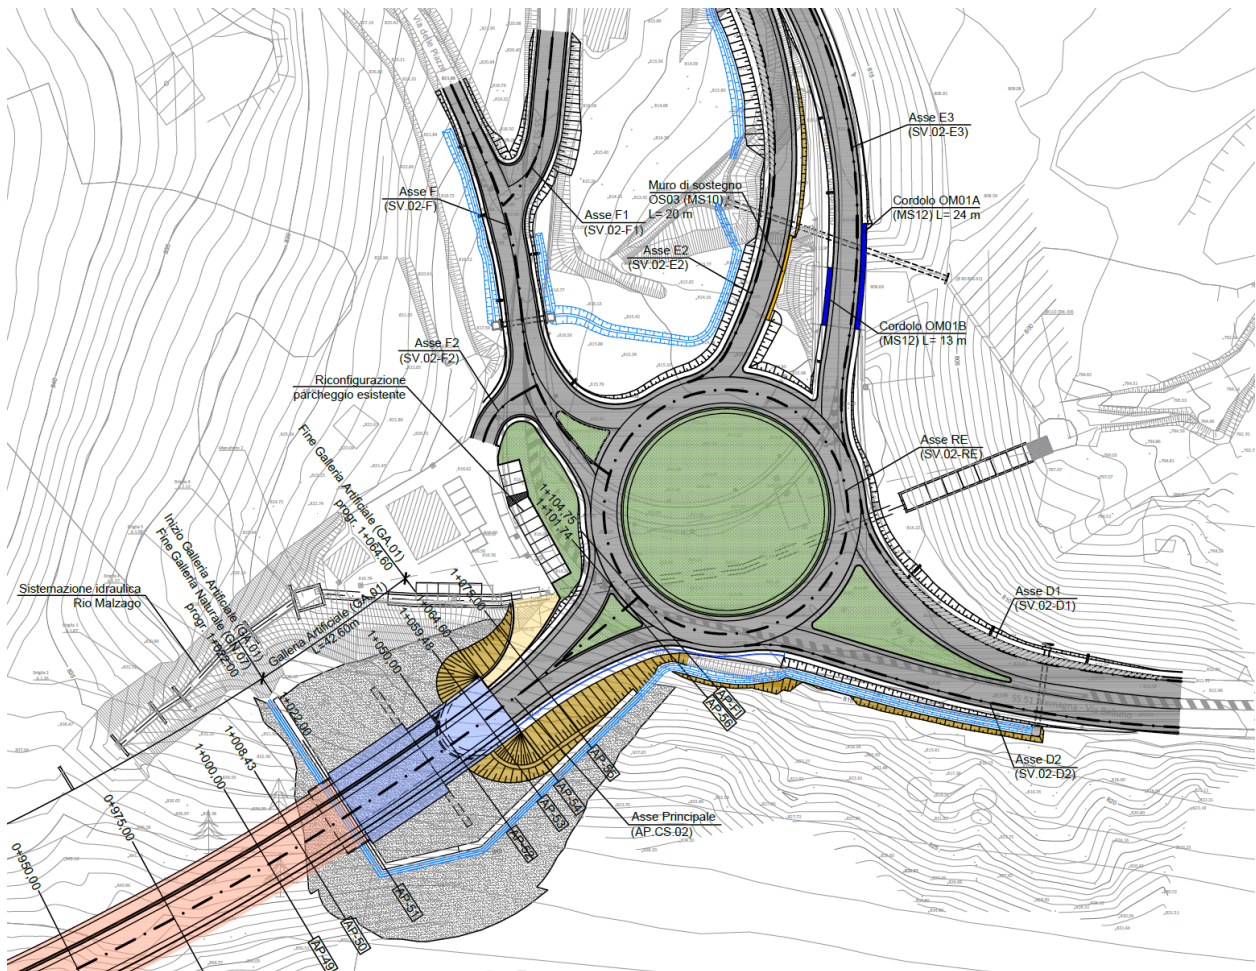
Stralcio planimetrico rotatoria svincolo Est
